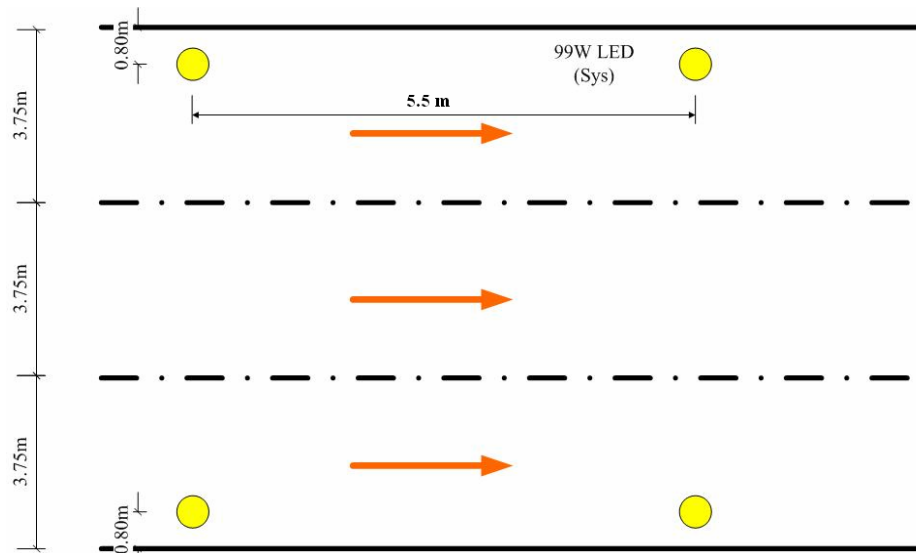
新店隧道 LED 燈平面配置示意圖
